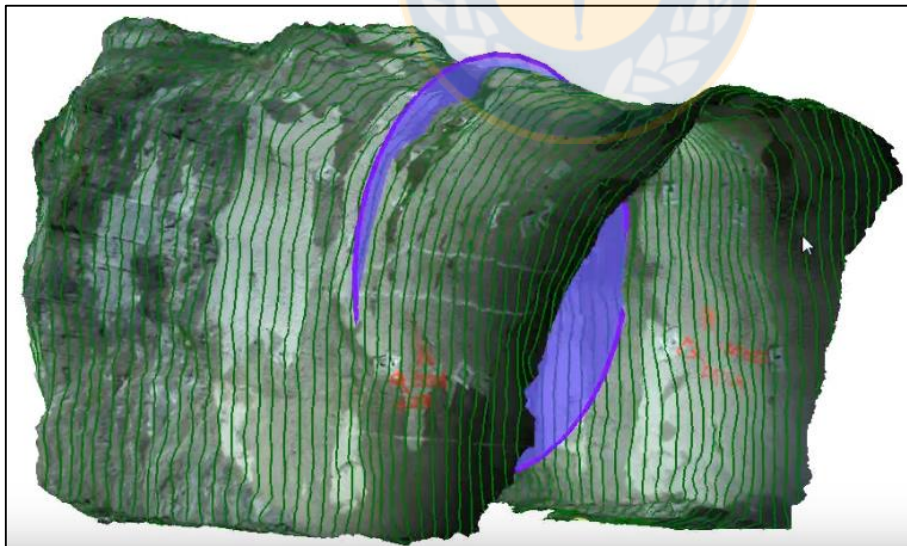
Nuevo plano modificado transversal a la excavación.
